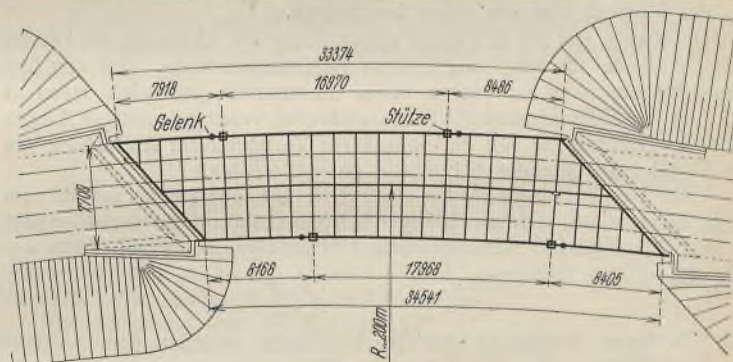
Grundriß der Straßenunterführung am Bahnhof Ruhleben.
